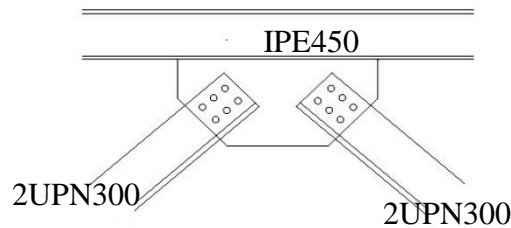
Assemblage gousset –contreventement à la poutre.
